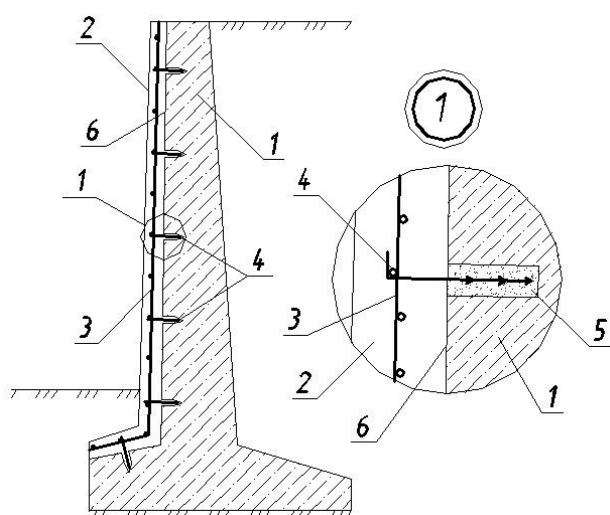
Улаштування залізобетонного нарощування в стиснутій зоні: 1 – підпірна стінка; 2 – бетонне нарощування в стиснутій зоні; 3 – арматурна сітка, прив'язана до анкерів; 4 – анкери; 5 – просвердлені отвори; 6 – підготовлена до бетонування поверхня
